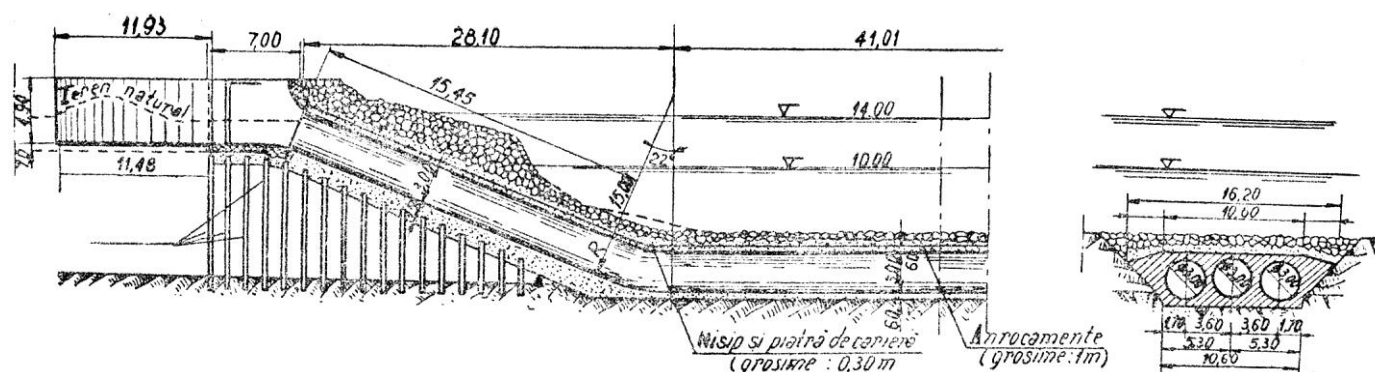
Sifonul de la Vidourle pe canalul principal al amenajării Rhônului inferior (profil în lung și secțiune) [3]
